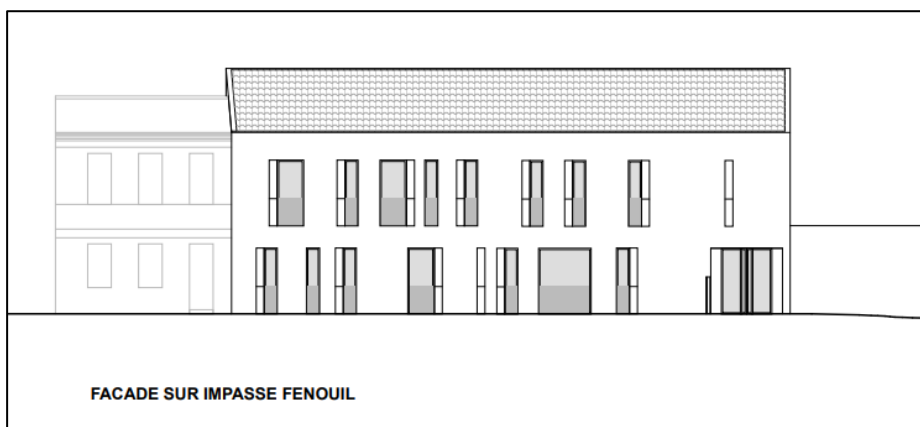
Façade sur Impasse Fenouil du projet en zone 2 (orange)
